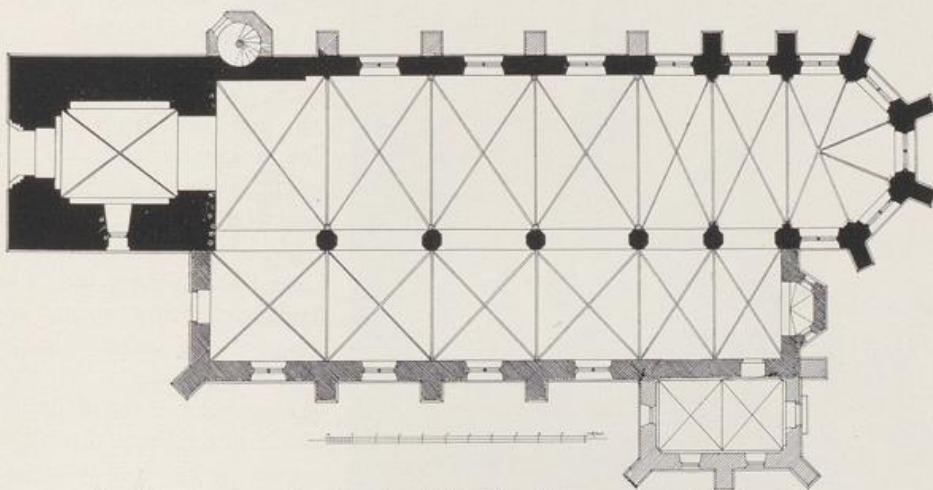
Kreuzau. Grundriss der kathol. Pfarrkirche vor der letzten Erweiterung.
